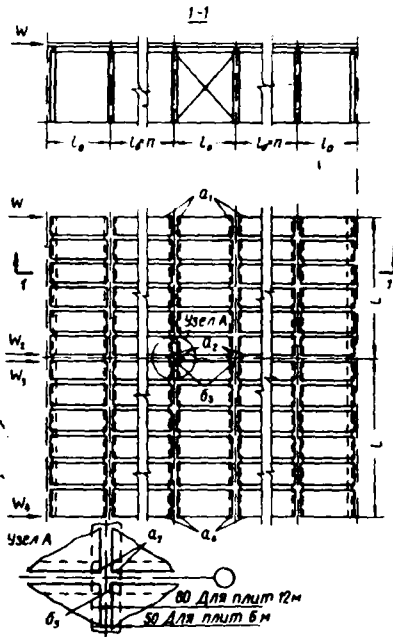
Расчетная схема (3) диска покрытия здания без кранов со скатной кровлей и вертикальными связями между колоннами (обозначения те же, что на рис. 2.14)
